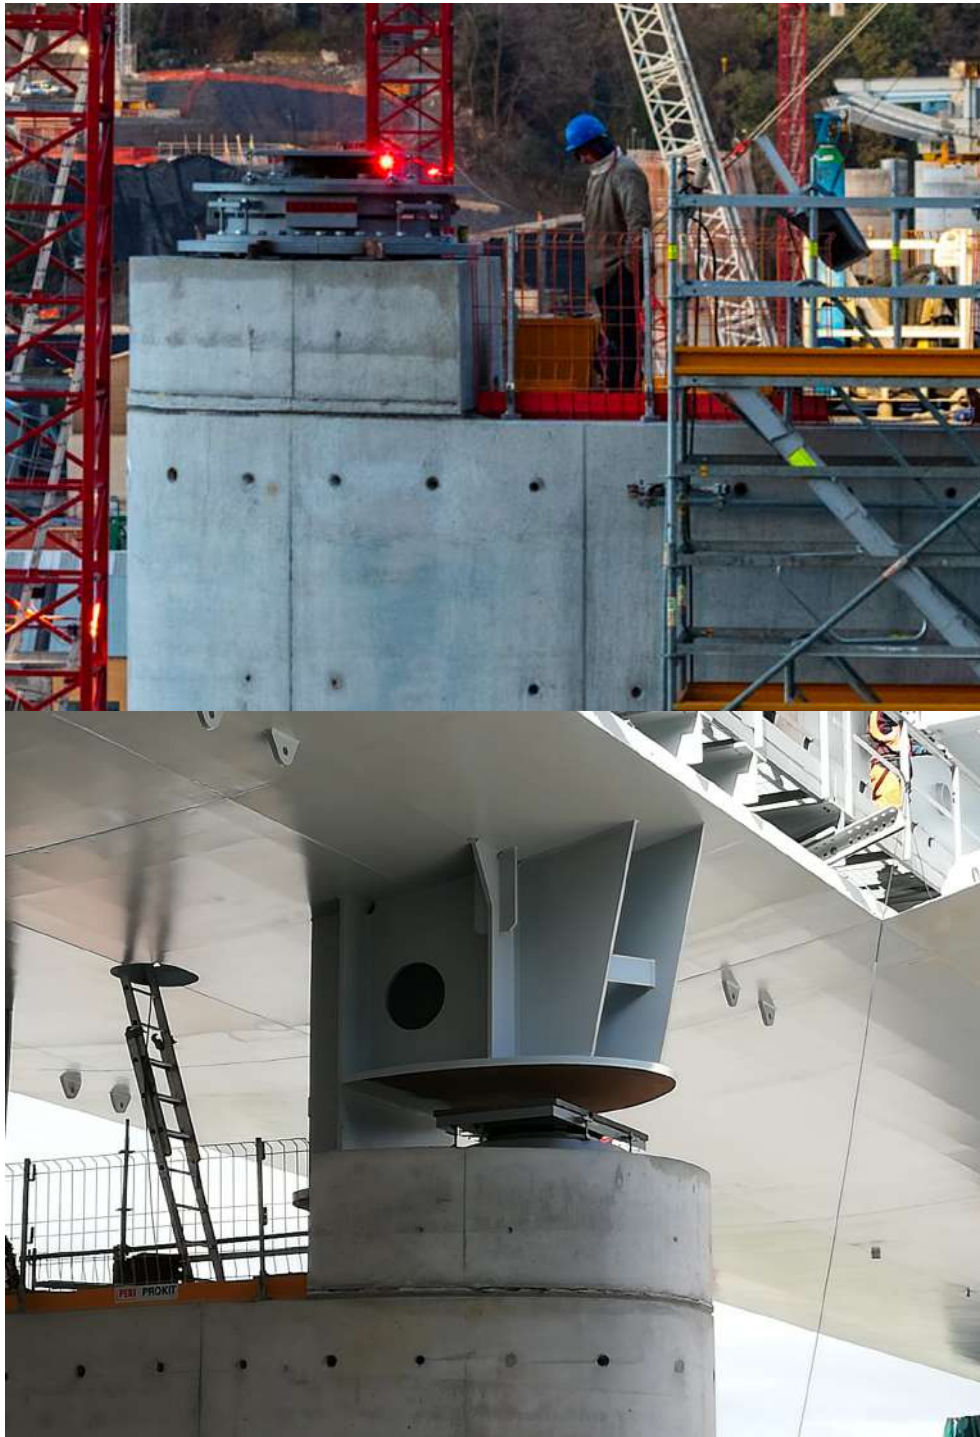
Apoio do tabuleiro em fase de construção e em serviço. Fonte: ITALFERR
